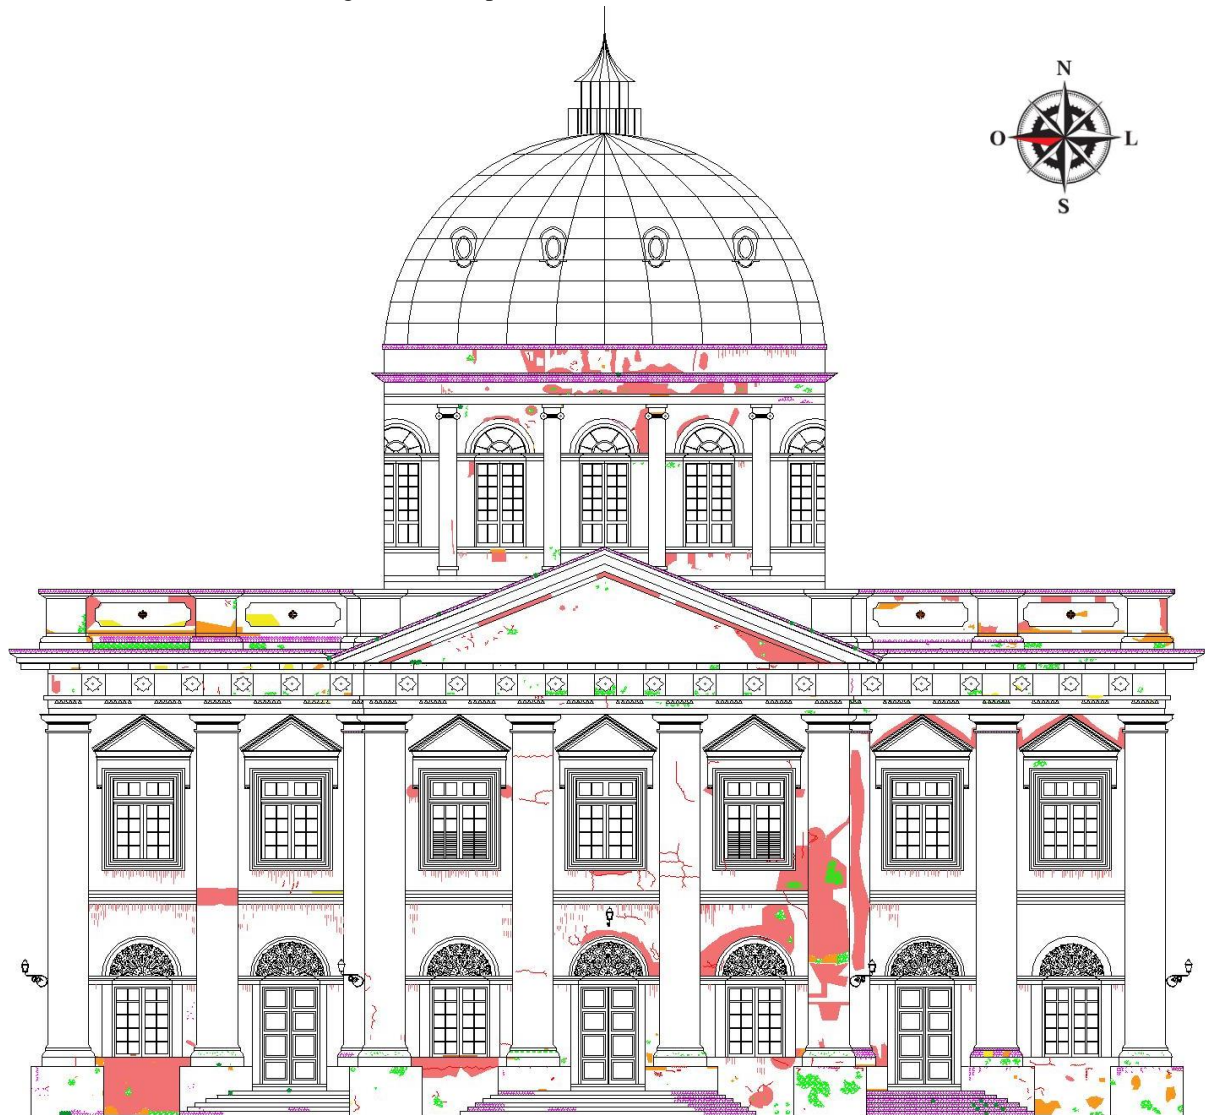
Destacamento de pintura, destacamento de reboco e fissuras, fachada oeste do PJN
